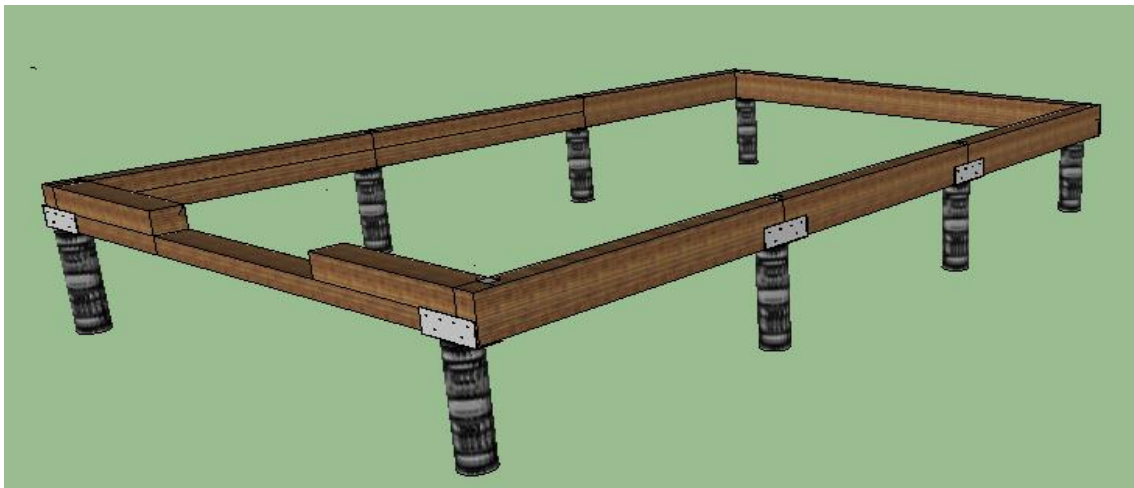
Vista de la base de madera armada con anclajes y pilotes de fijación
